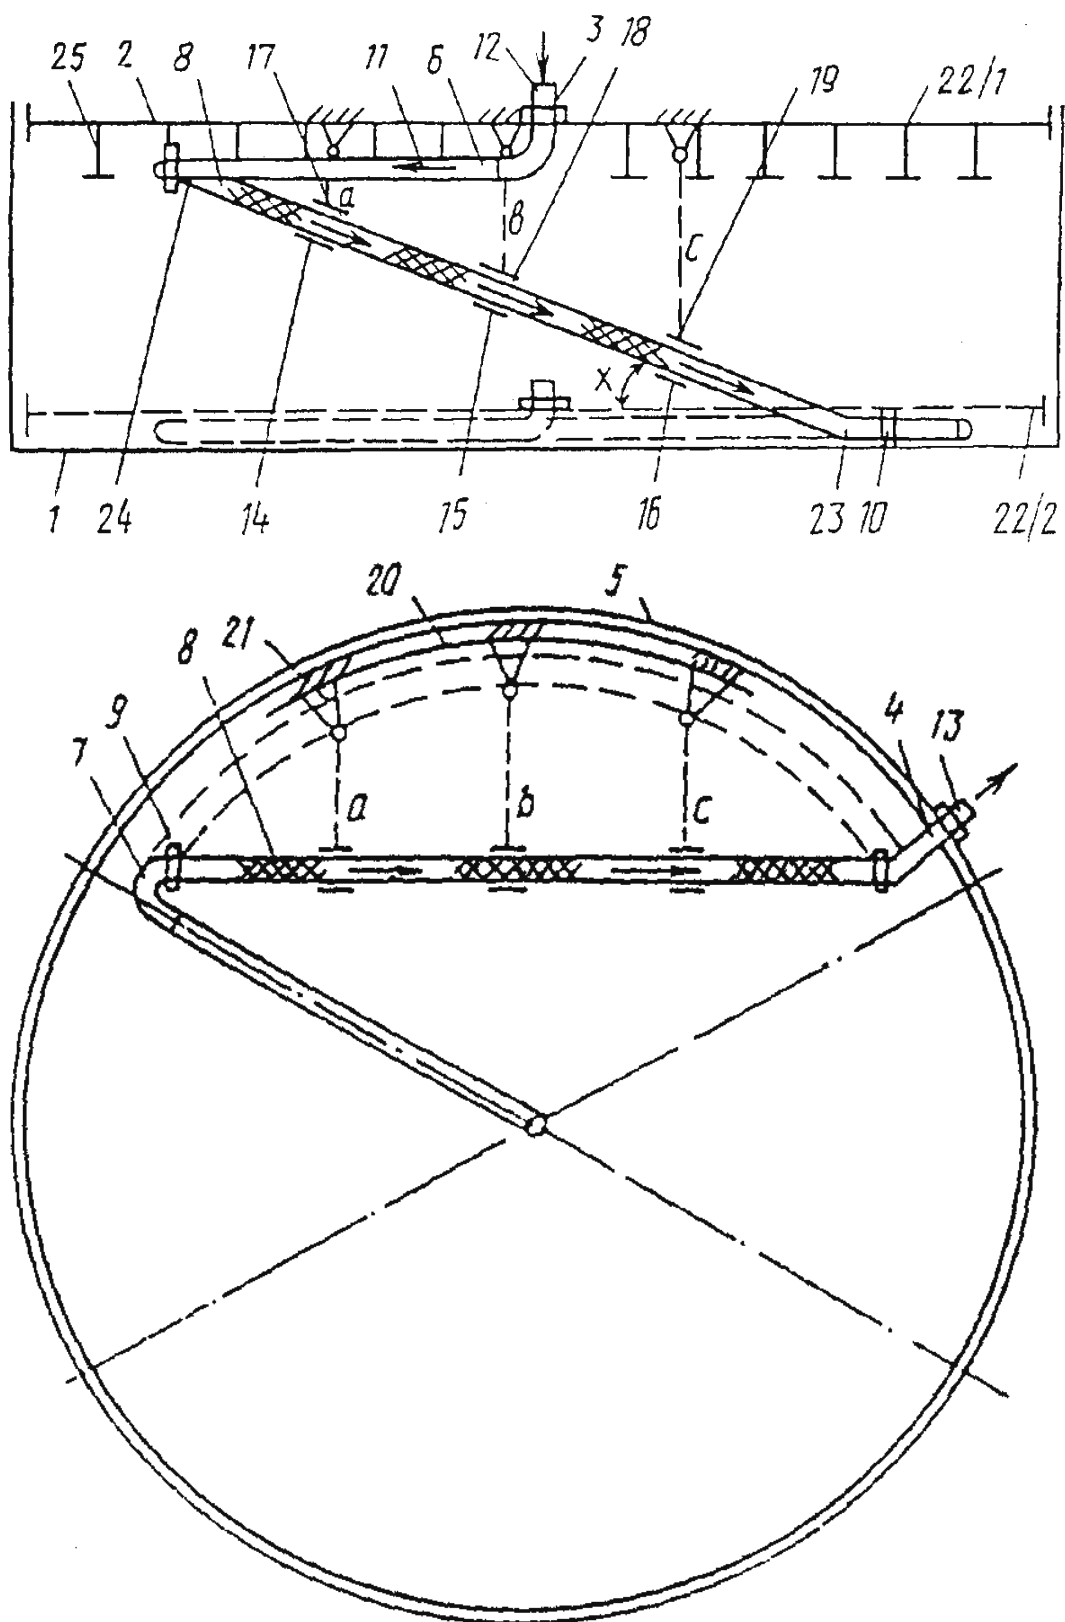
Конструкция водоспуска с плавающей крыши резервуара
